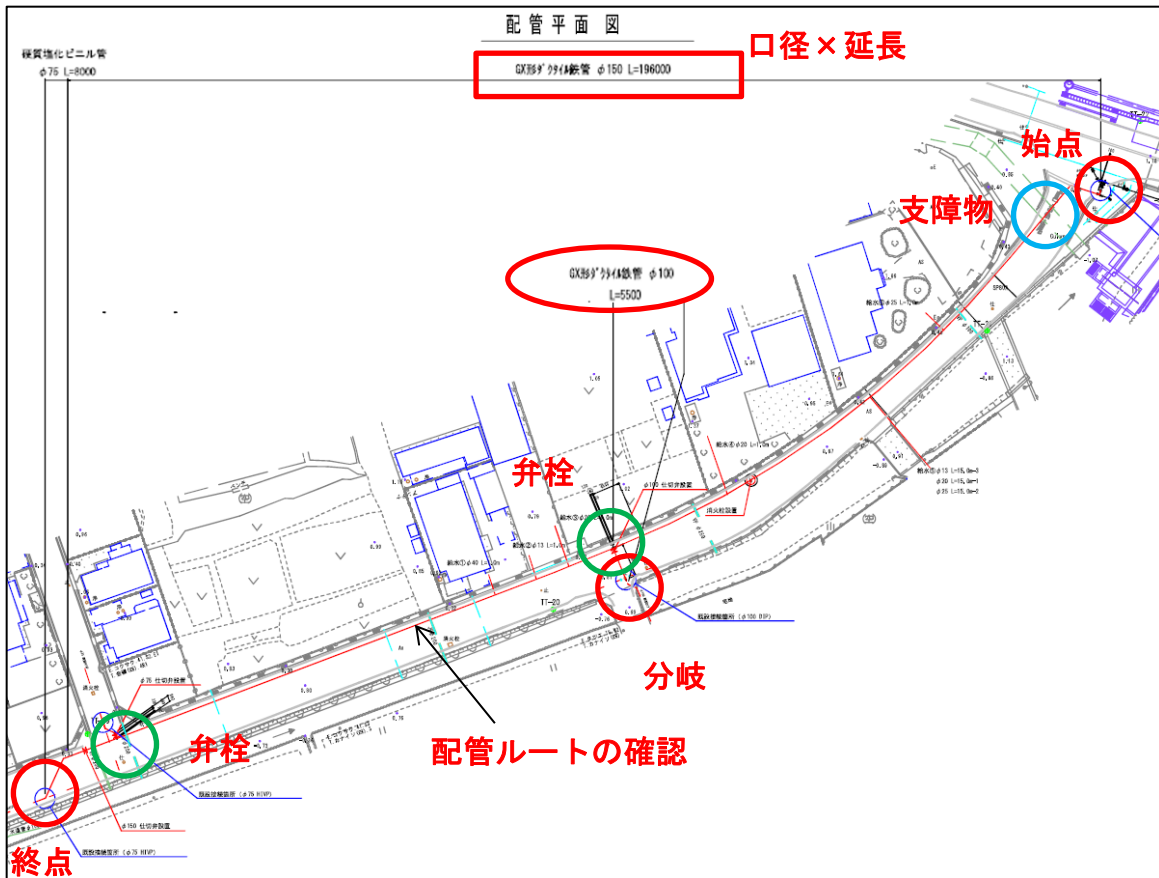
発注された設計図書（当初設計の平面図）の確認例
